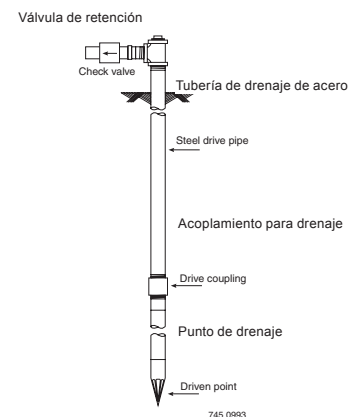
INSTALACIÓN DE PUNTO DE DRENAJE
